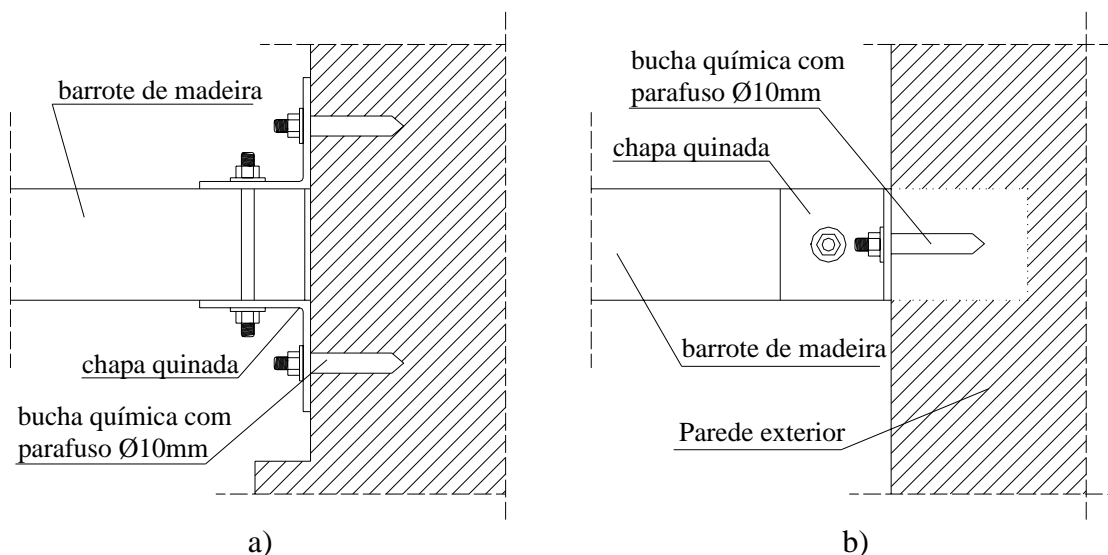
[4d]: Pormenor do reforço de ligação dos barrotes do pavimento do coro à fachada; a) Planta; b) Corte transversal
